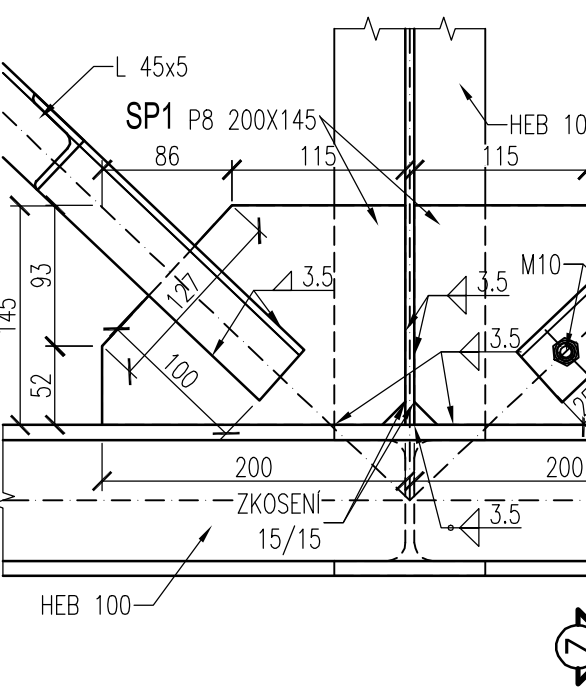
MONTÁŽNÍHO SPOJE S1 M 1:5
